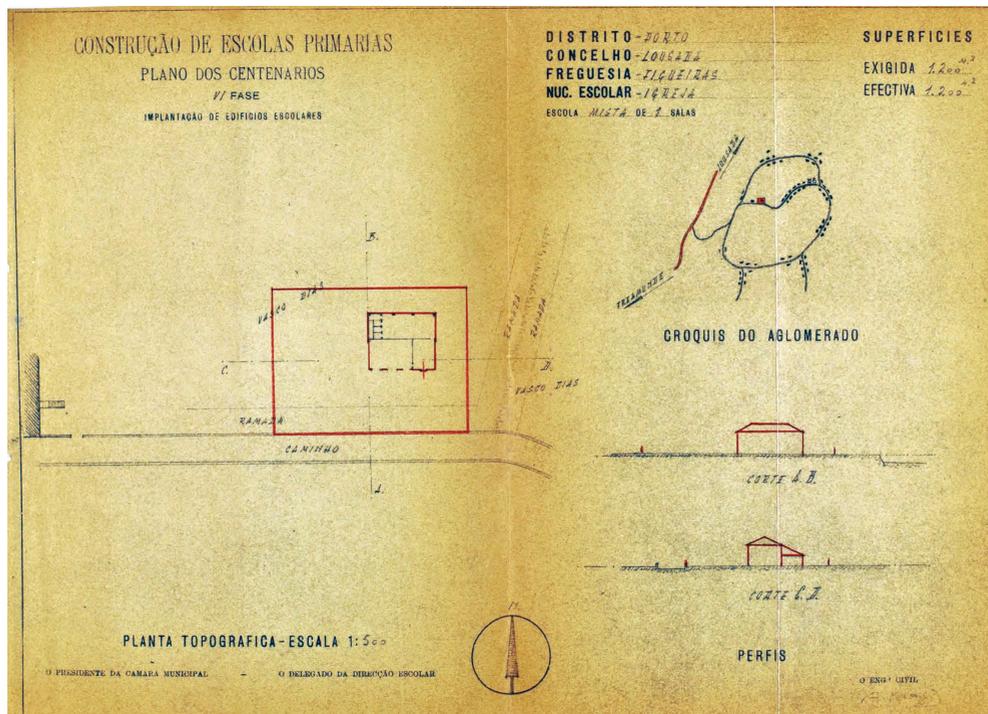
Planta topográfica, à escala 1:500, da escola mista, de uma sala, de tipo rural, inicialmente planeada para o núcleo escolar de Igreja, Figueiras (DGEMN - DOCEP, 1956).
